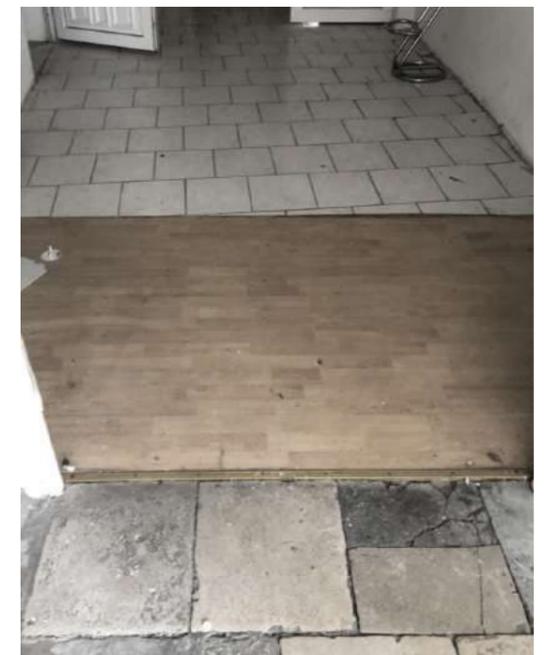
Raum 2.09, Außenwand zum Hofberg, Parkettboden aus BP5, Balkendecke und Unterzug, abgefaste Balken (BP2) ③
